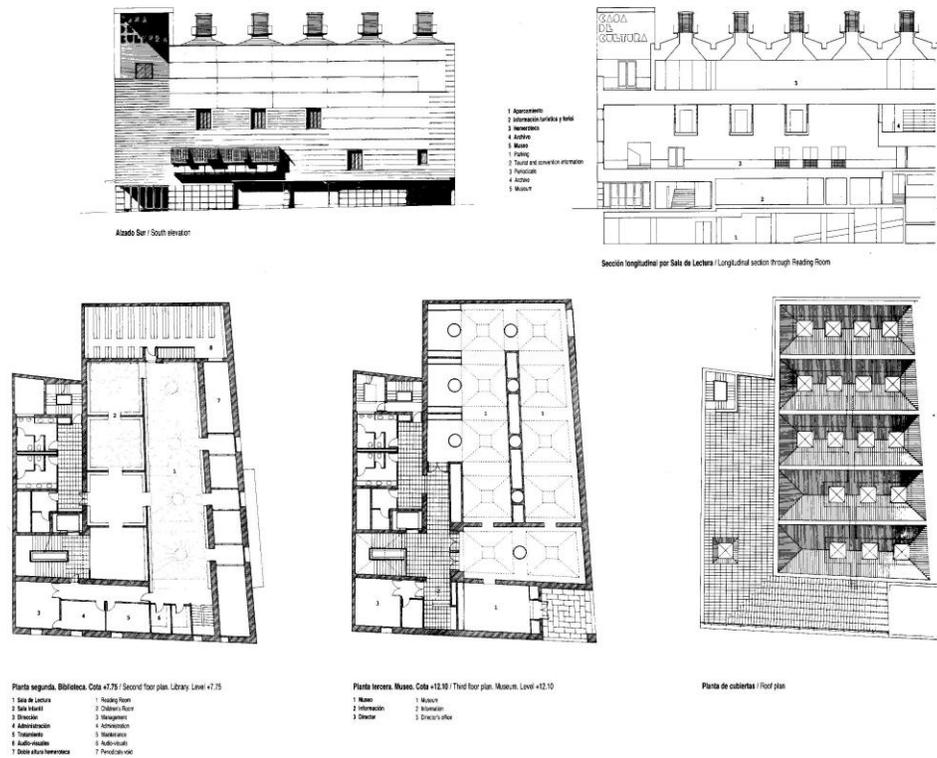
, plantas y secciones, Casa de la Cultura., fuente: Revista el Croquis edit. 98. 1999
